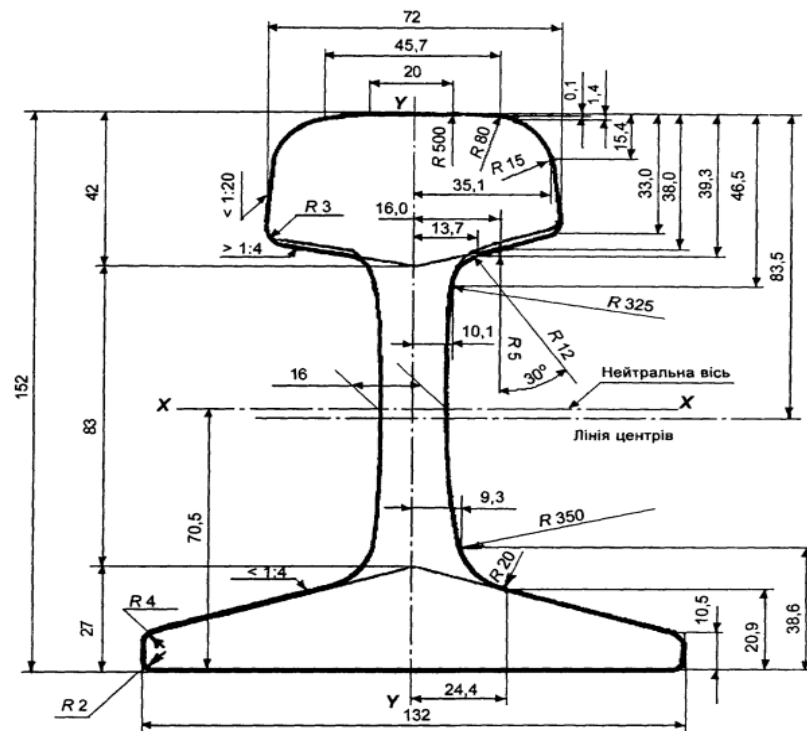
Поперечний переріз рейки типу Р50
